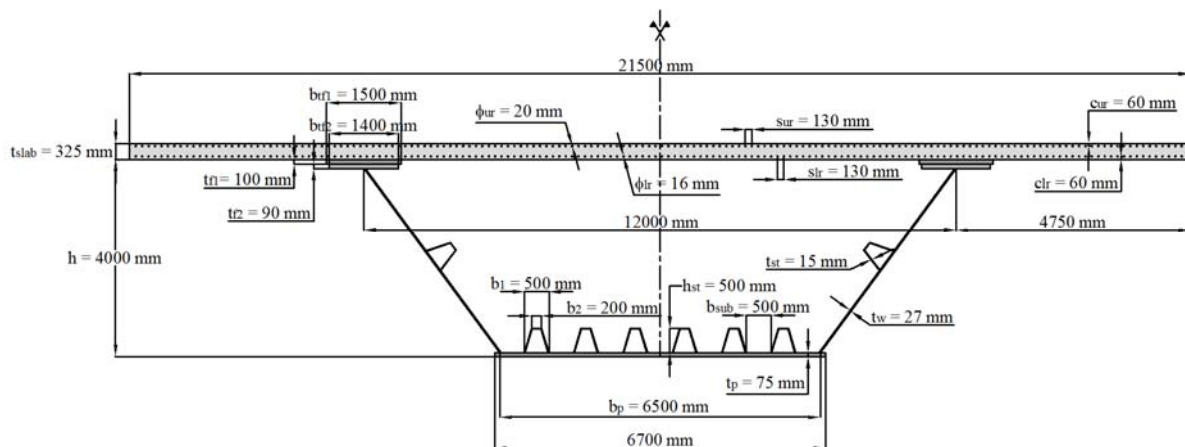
Querschnitt der Hohlkastenbrücke am Zwischenaufleger P3.
